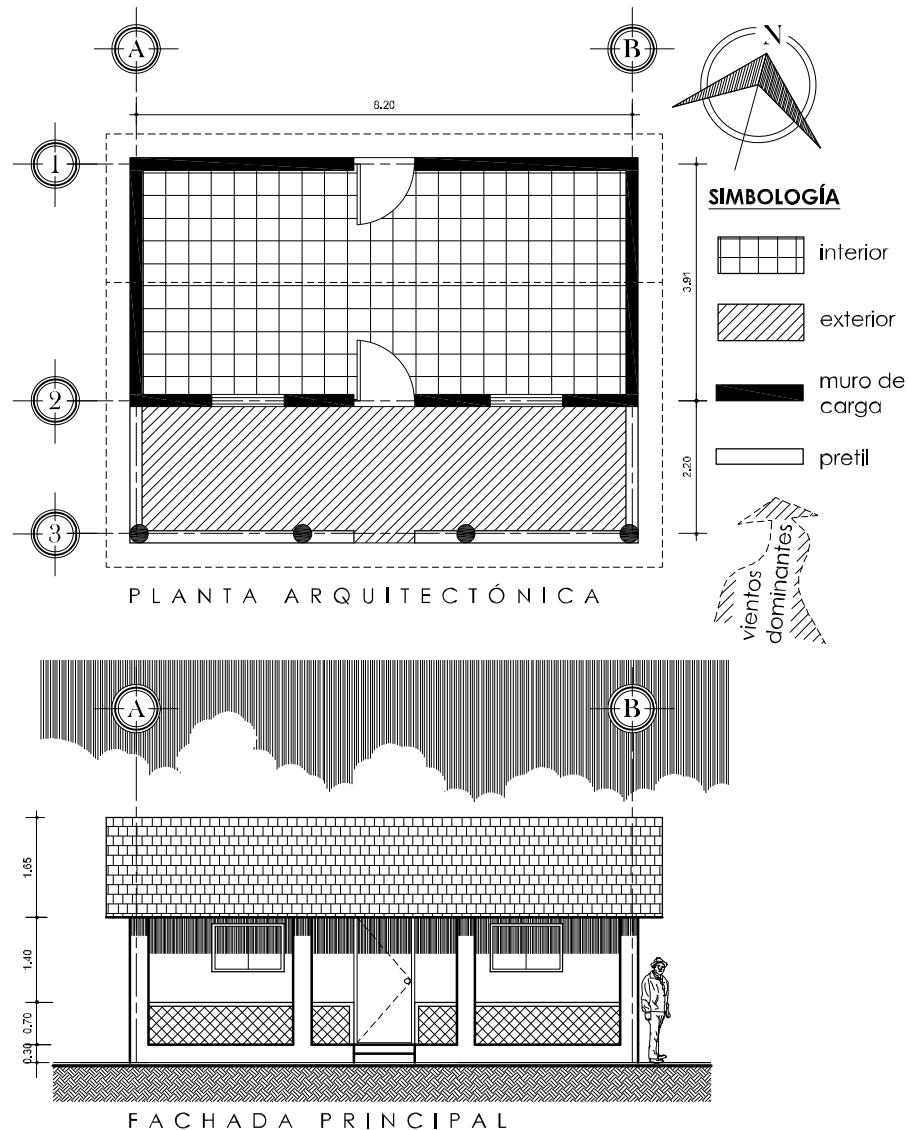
VIVIENDA 1 FUENTE: Levantamiento realizado por Alejandro Ocampo Arcos.
